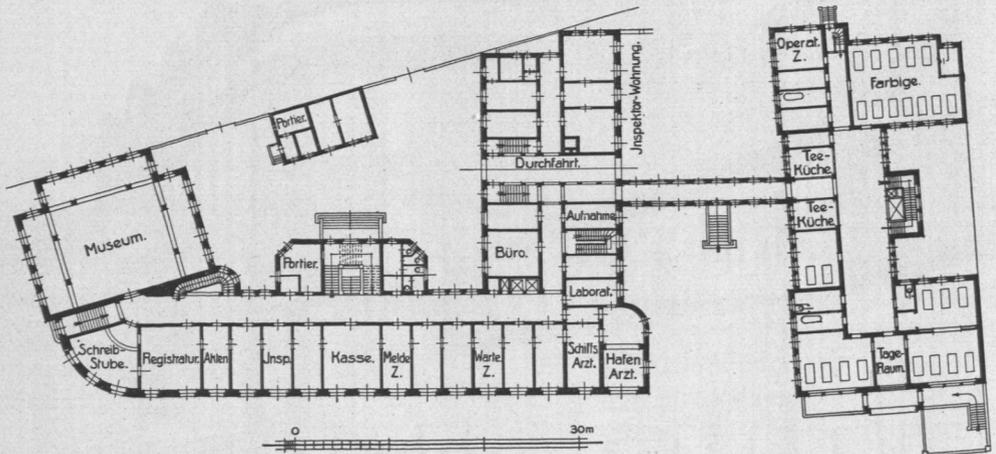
Institut für Schiffs- und Tropenkrankheiten, Hauptgebäude, Erdgeschöß, Grundriß.
